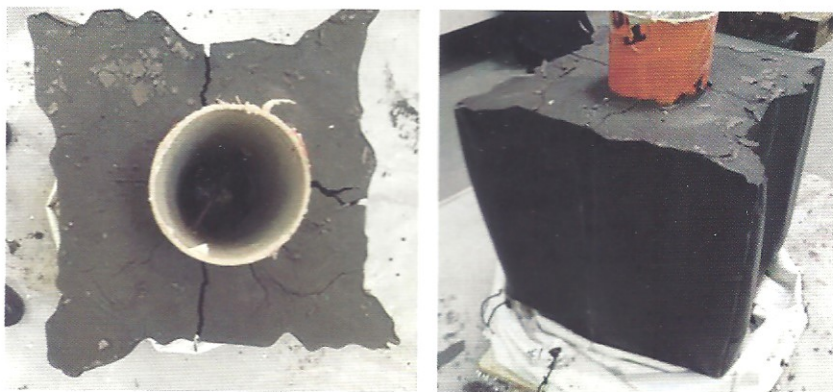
Resultado da descofragem sendo visível o aparecimento de fissuras e rachaduras superficiais
